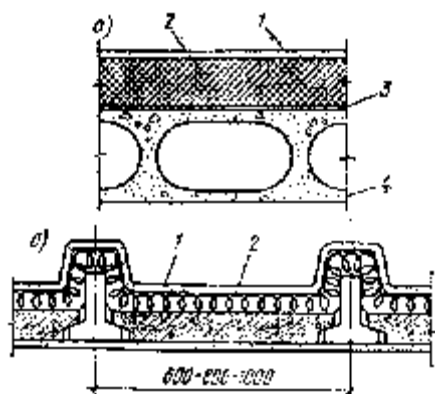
Чердачные сборные железобетонные перекрытия: а – с утеплением поверх настила или панели; б – с утеплением балок; 1 – известковая корка; 2 – утеплитель; 3 – пароизоляция; 4 – настил или панель перекрытия.
